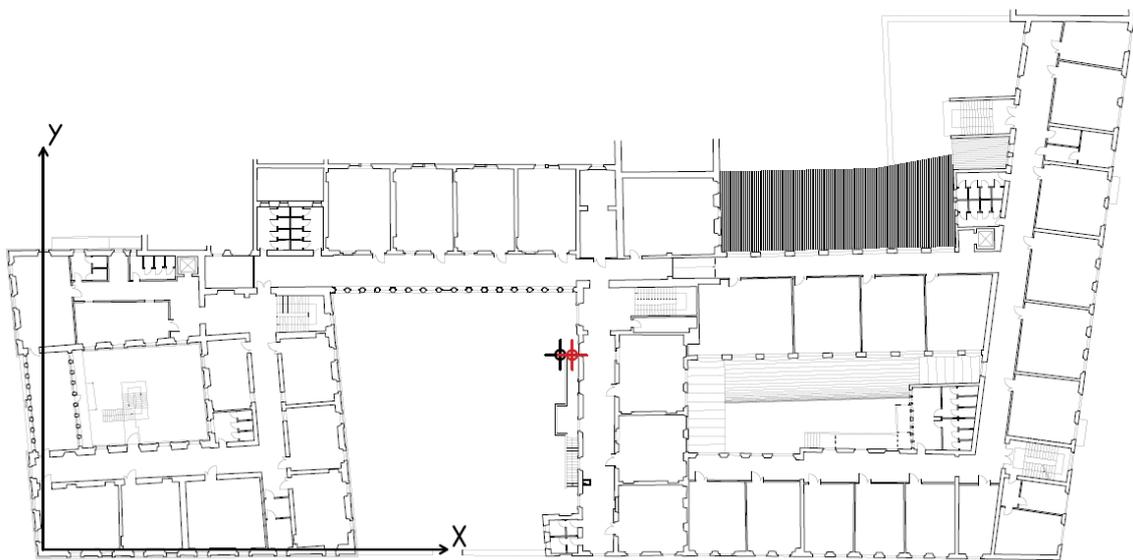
Posizione centro di massa e di rigidezza al piano primo (in rosso il centro di massa)
